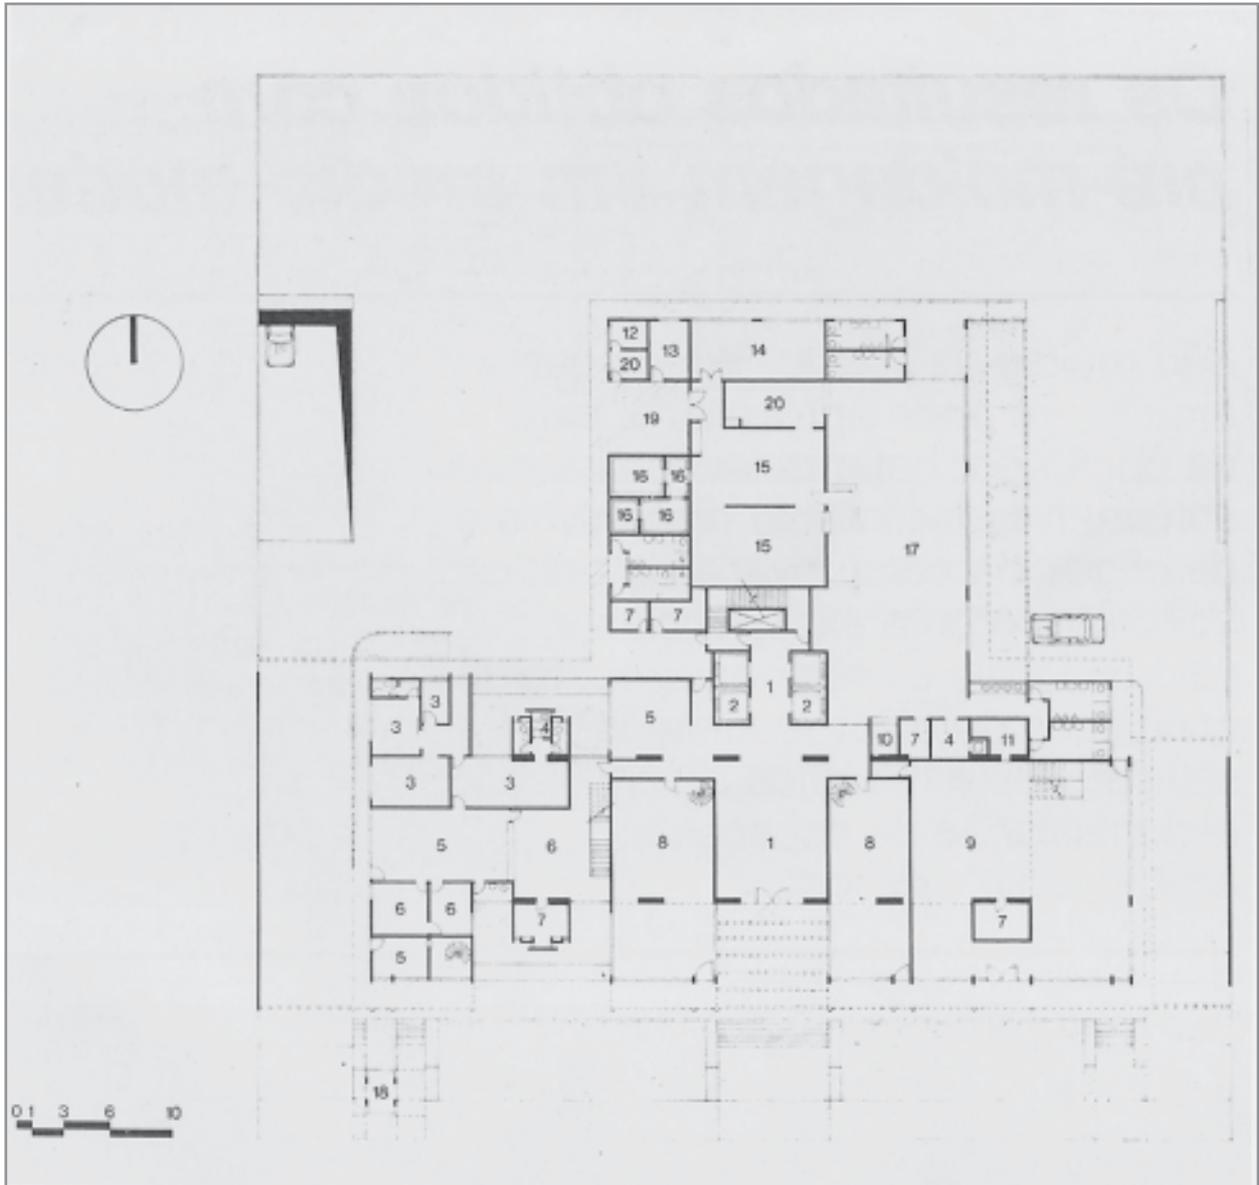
Planta do Pavimento Térreo - Fonte: Revista Projeto nº 110, Maio de 1988, página 90.
